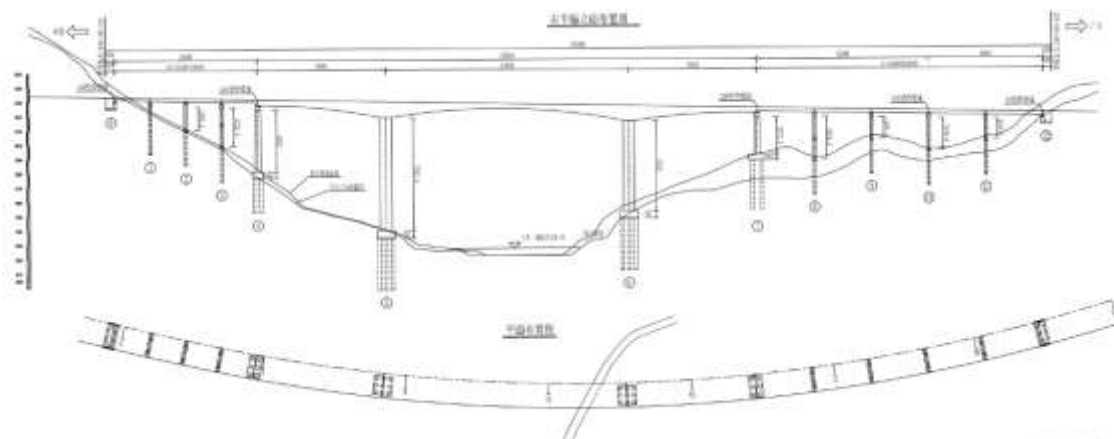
南河一号特大桥（右幅）立面布置图
